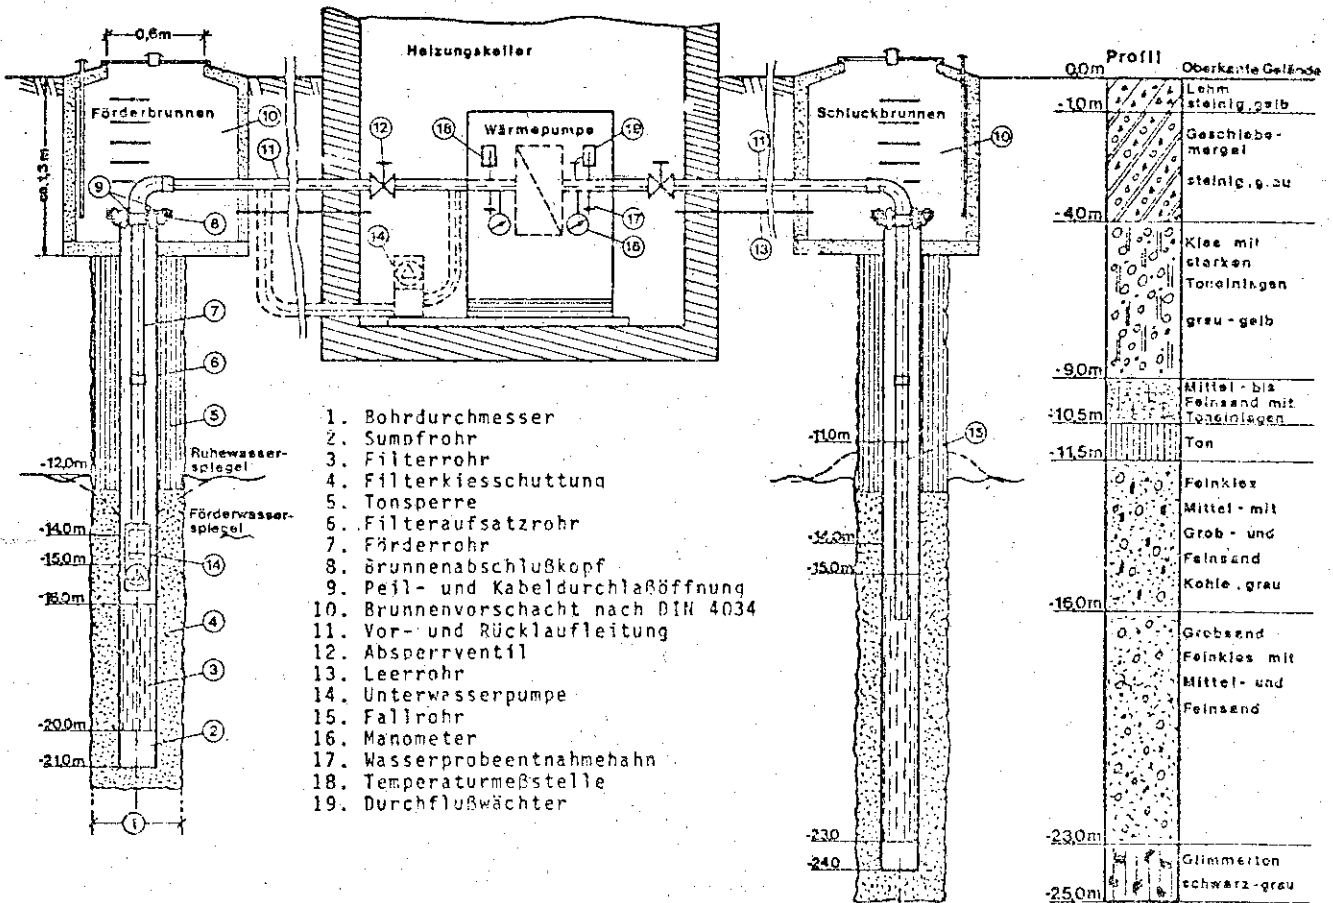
Schema einer Brunnenanlage für eine Grundwasser-/Wasser-Wärmepumpe
